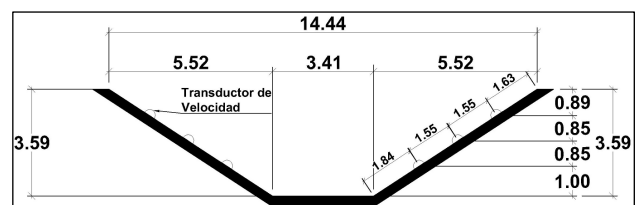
Sección del canal del caudalímetro del GC N° 15. Caudales en esta sección: Hasta 32 m³/s. S₀=0,15‰. (Cotas en m).
